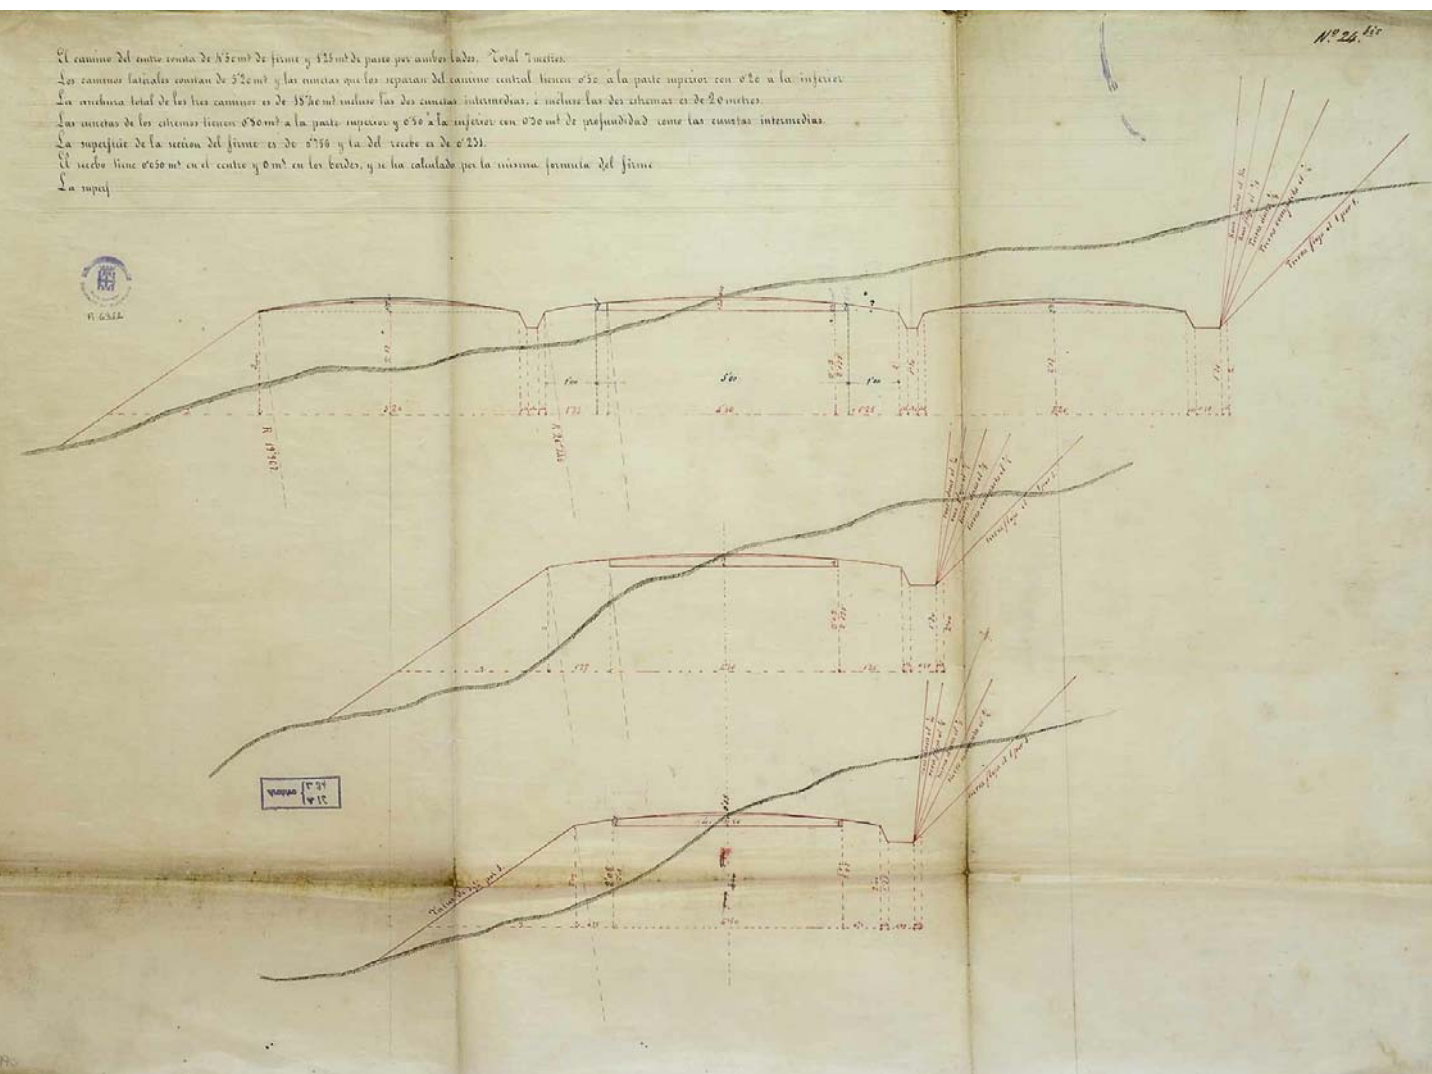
Seccions transversals previstes per al tram de la carretera entre Sarrià i Sant Andreu. 1873 (AGDB, OP-502)
